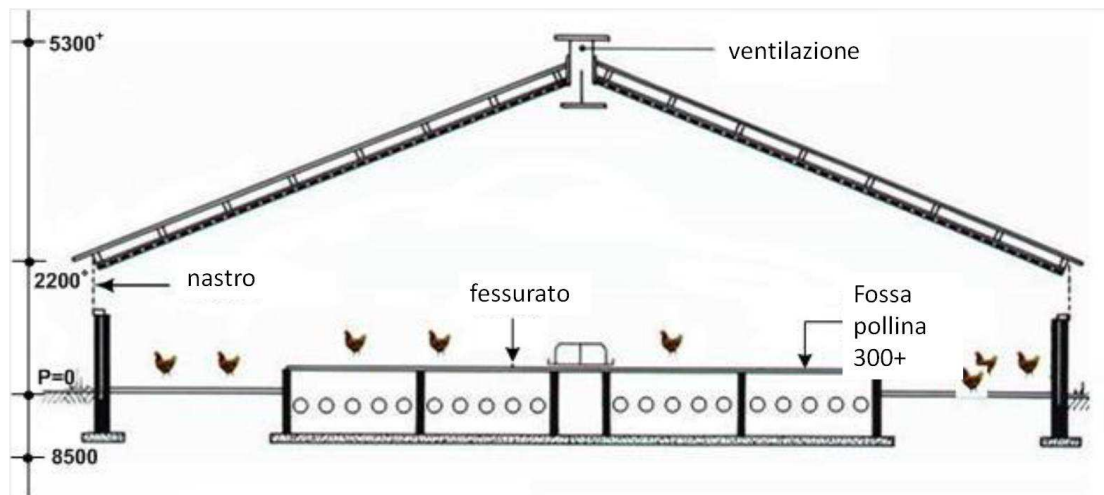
Sistemi con lettiera profonda con aria forzata tramite tubature sottostante la pavimentazione fessurata
